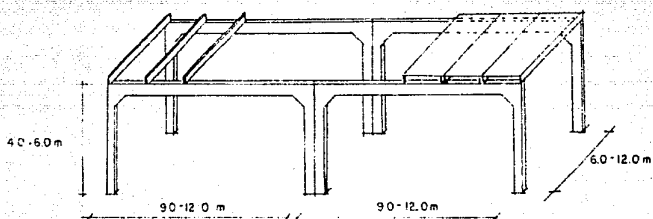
NAVE DE CRUJIAS MULTIPLES A BASE DE MARCOS RIGIDOS.- La cubierta puede formarse con largeros y lámina estructural, o con losas prefabricadas.
